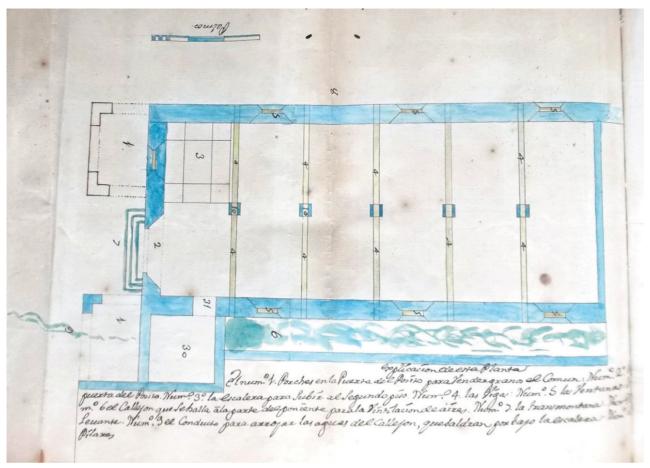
Plano planta Pósito de Orihuela. Proyecto de J. V. Alcayde 1755 (A.M.O.) D 571, fol. 63
